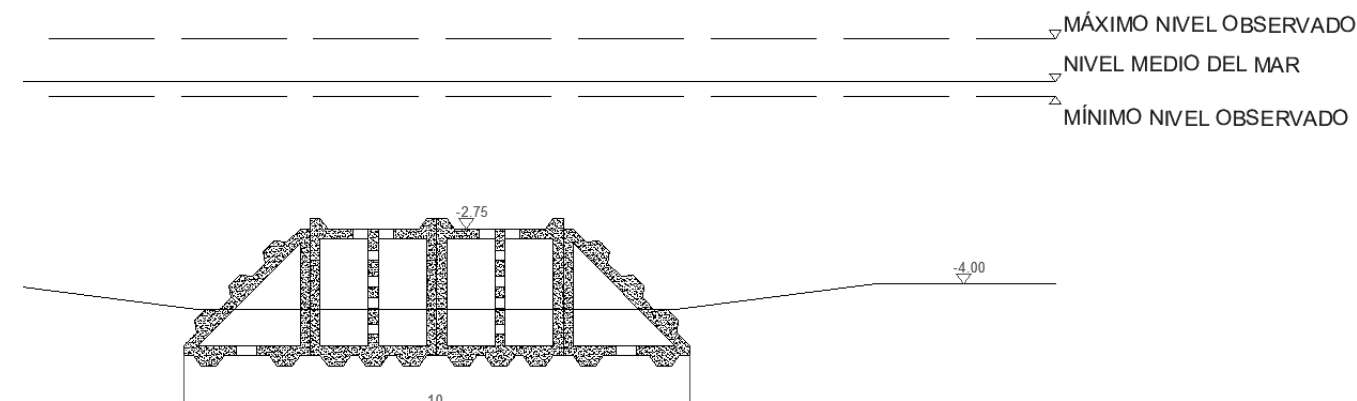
Prediseño de configuración T2CT con estructuras modulares. (Fuente: plano 6, 2023)
